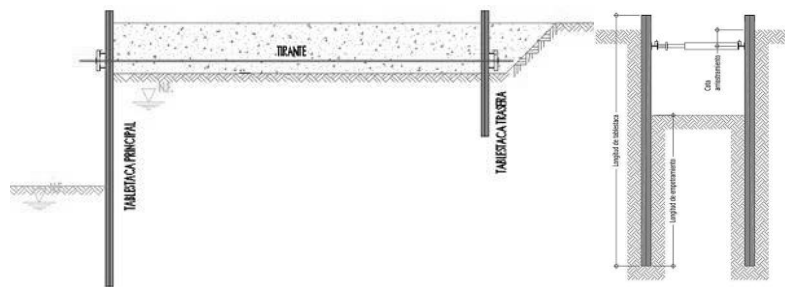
Tablestacado arriostrado o apuntalado. Tomada de «Fundamentos de ingeniería de cimentaciones», por Trejo, 2019, p. 18.
